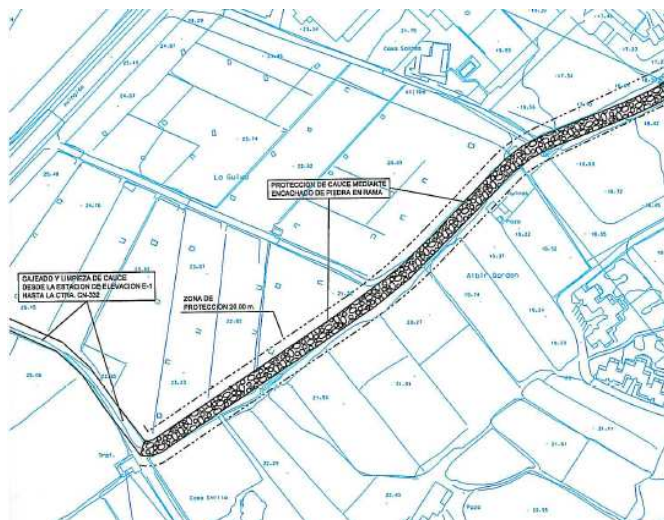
Vista de parte del Extracto del Plano “Planta de Obras de Fábrica y Muros de mampostería” del proyecto de Liquidación Modificado N°1 Encauzamiento Barranco Hondo Tramo 1, en Alfaz del Pi.
